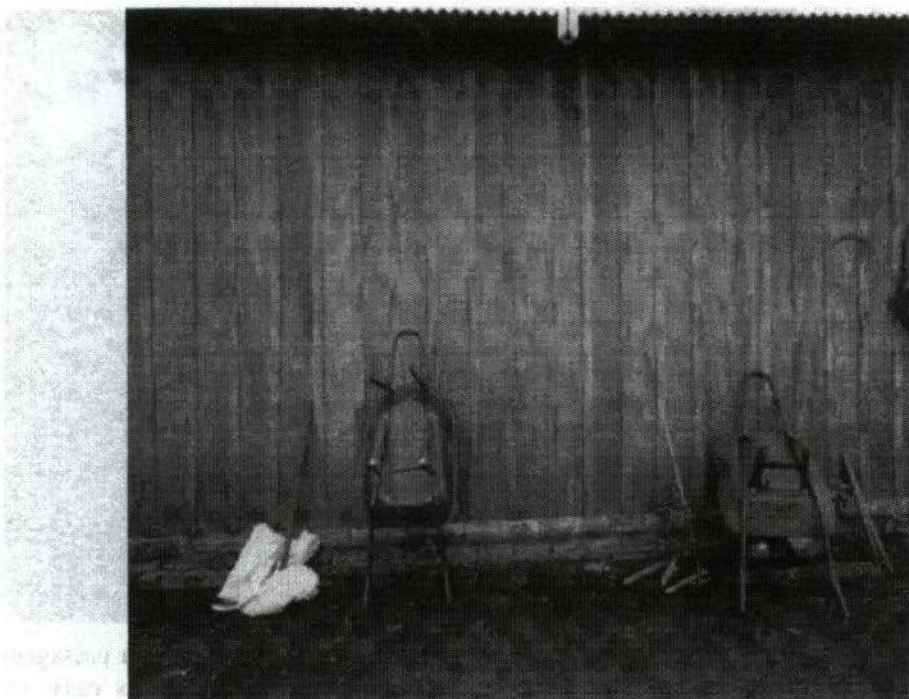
Casa edificada com base de tijolos, sem que tenha sido chapiscado ou rebocado e sem calçada, em aldeia da etnia Araweté.
